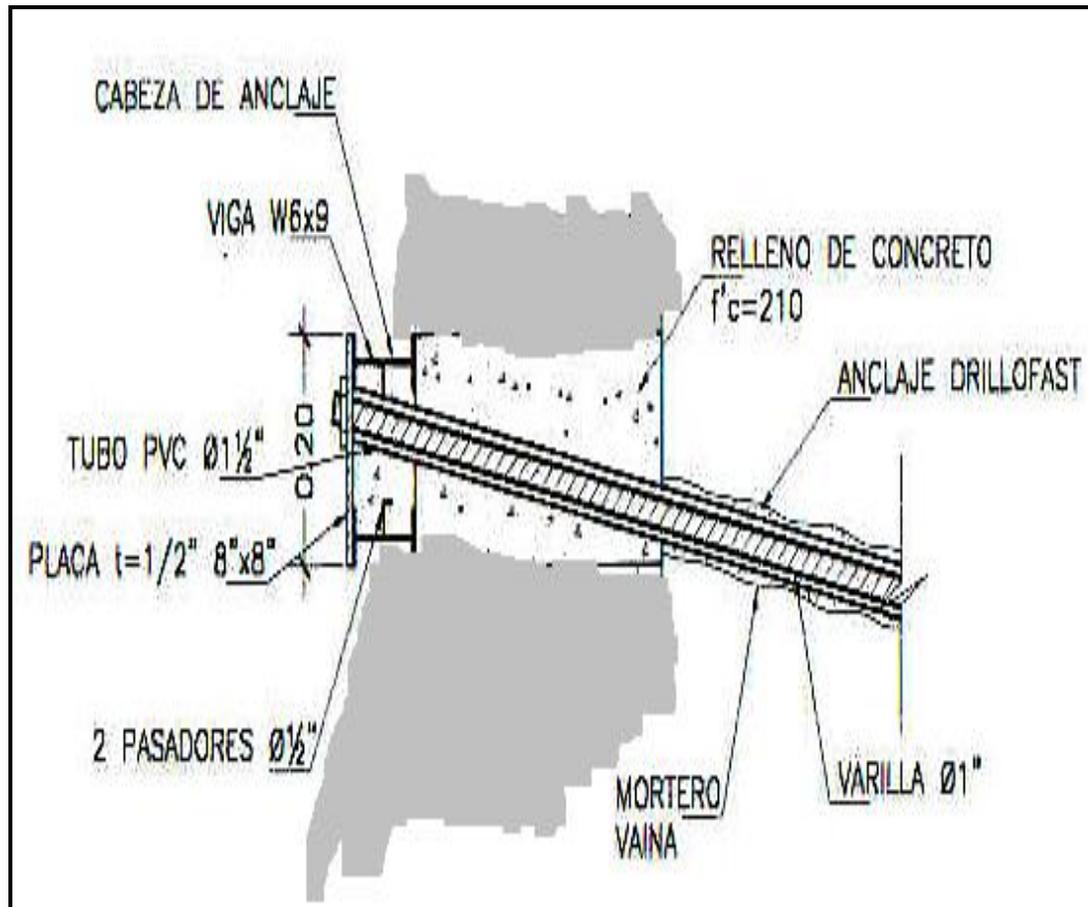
Detalle de cabeza de anclaje, relleno de concreto y mortero vaina.²
